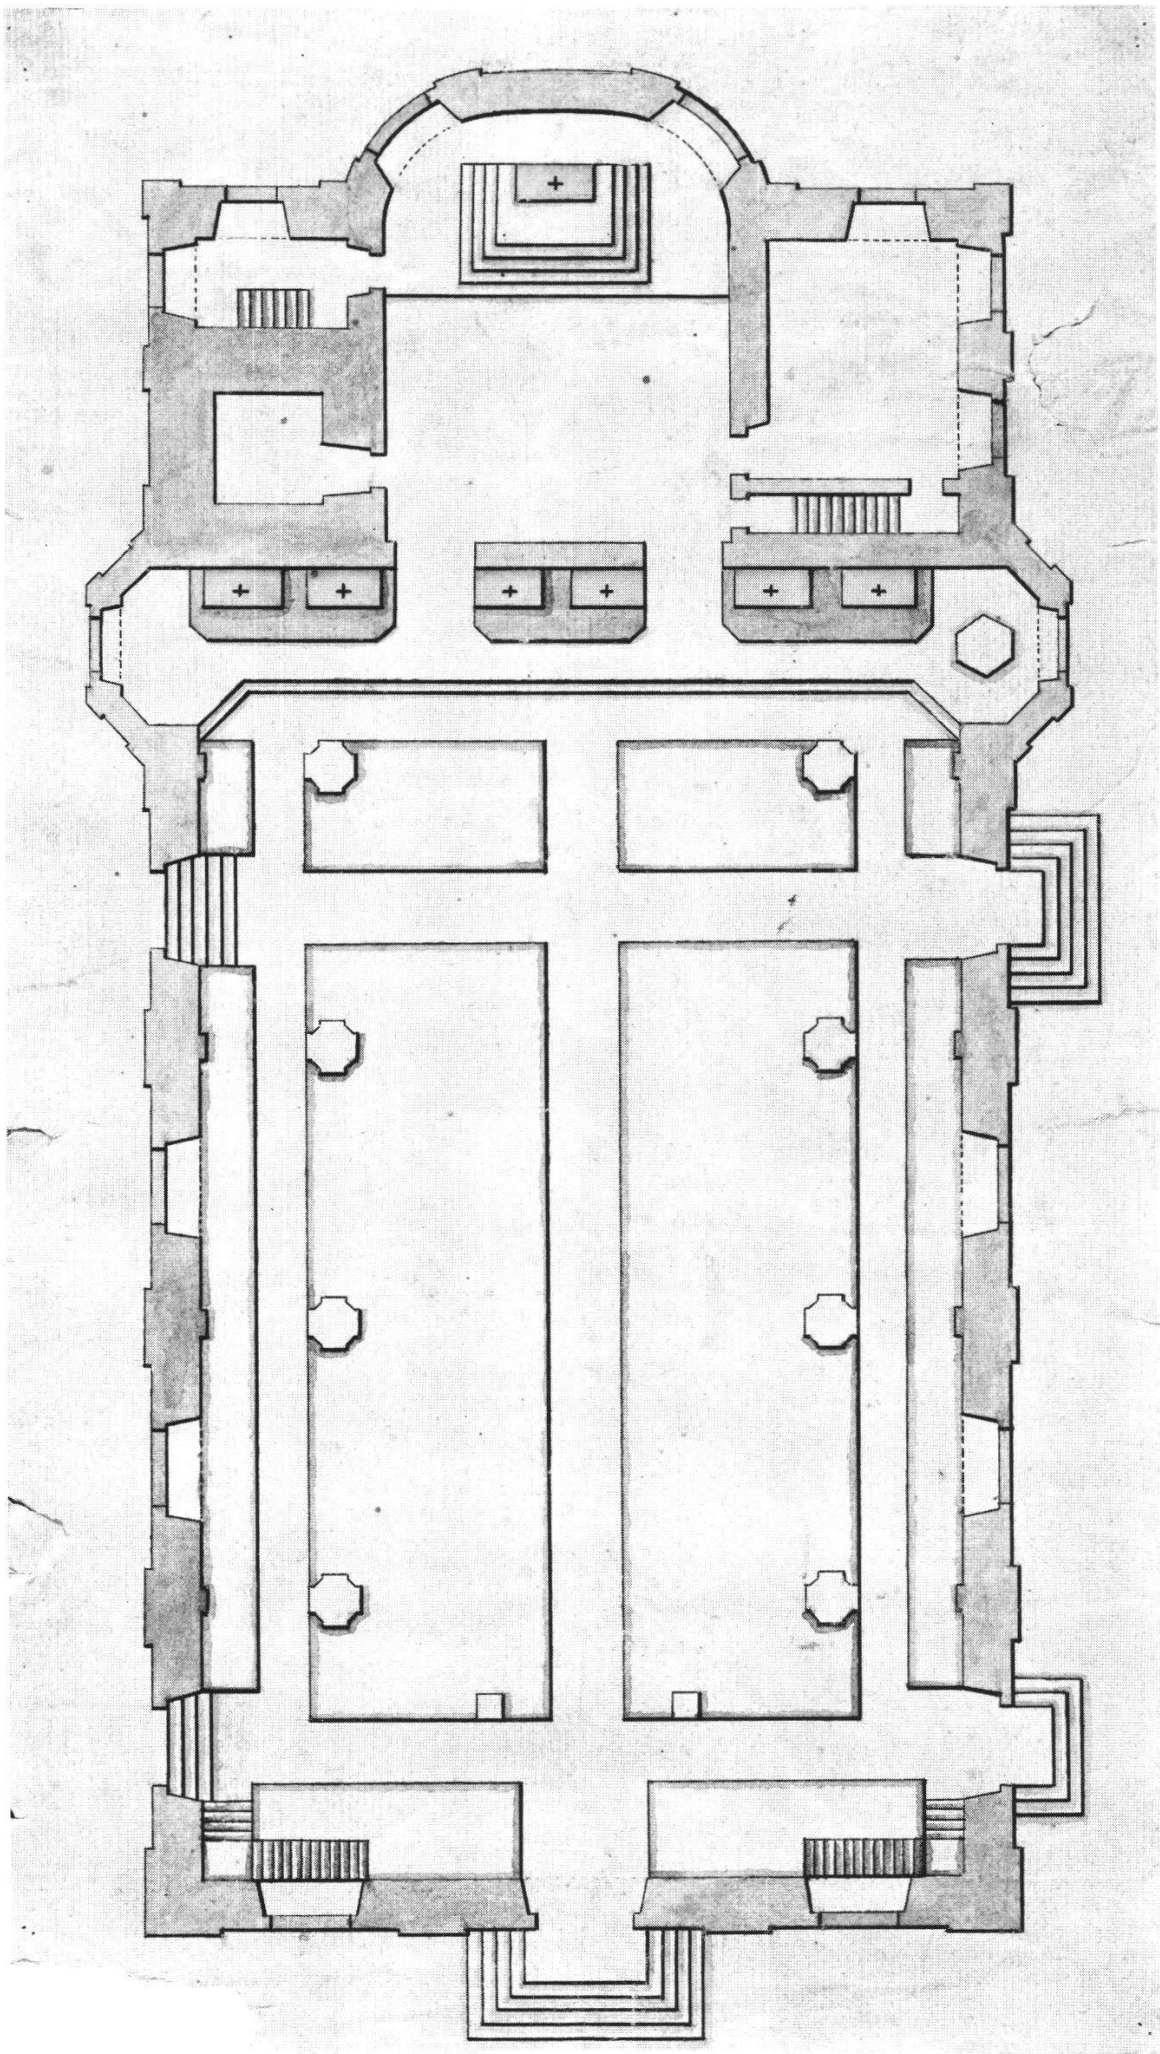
Schwyz. Pfarrkirche. Grundriß.
